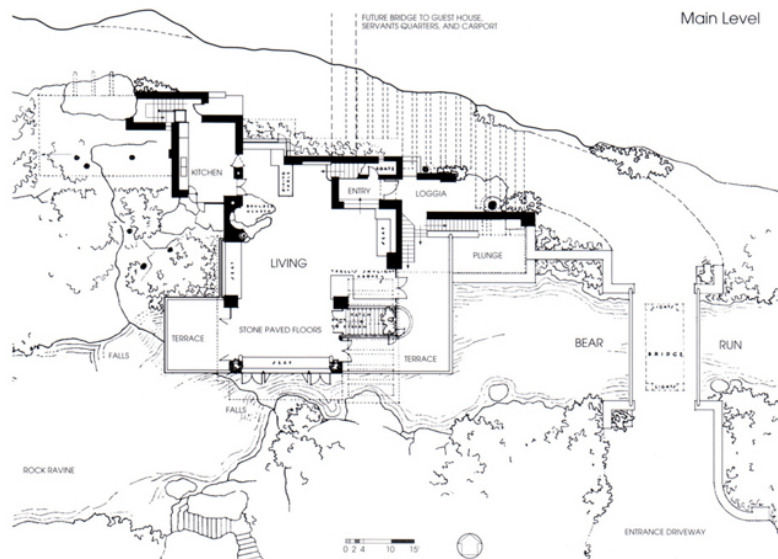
PLAN RDC: FALLING WATER, FRANK LLOYD WRIGHT: <http://www.greatbuildings.com/>
